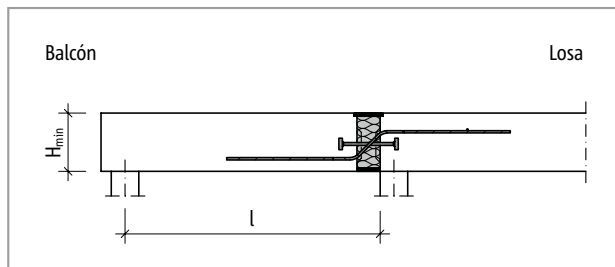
Schöck Isokorb® T tipo Q-P: Sistema estático
